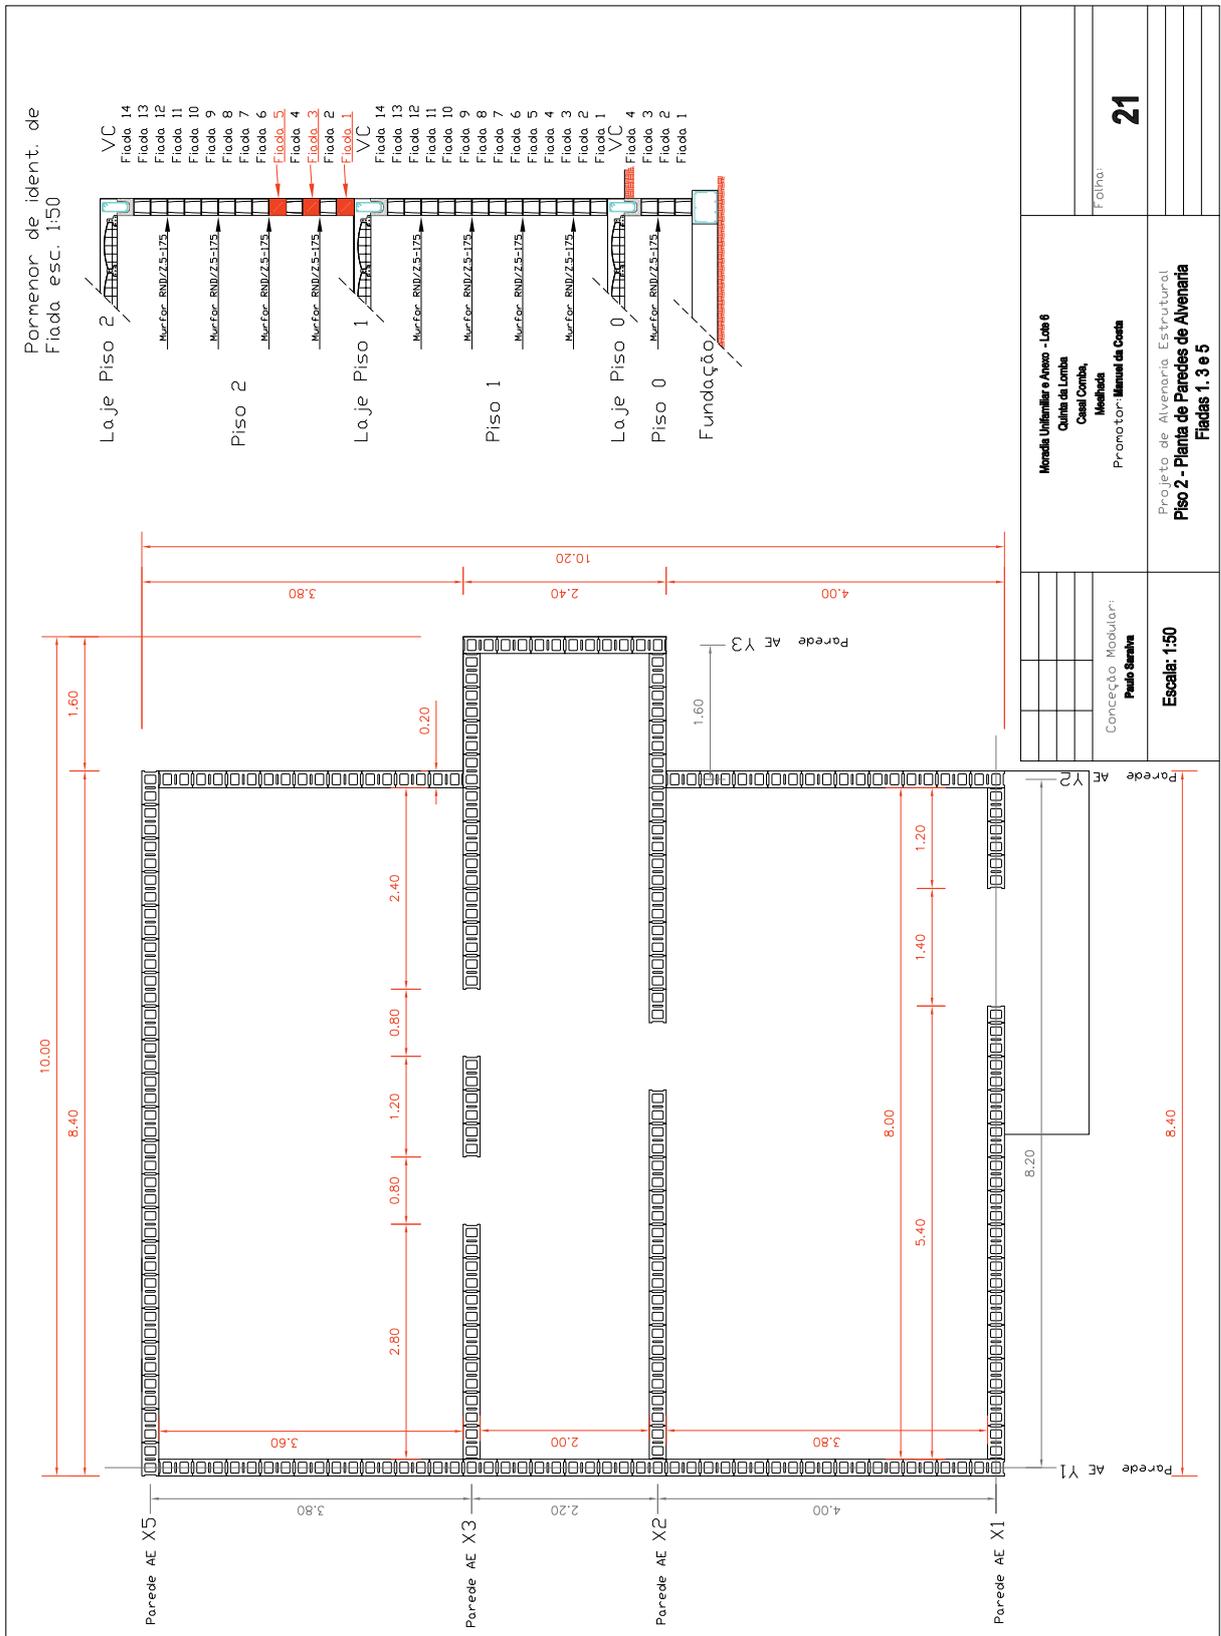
Planta das fiadas 1, 3 e 5 do 1º piso da solução em AE
